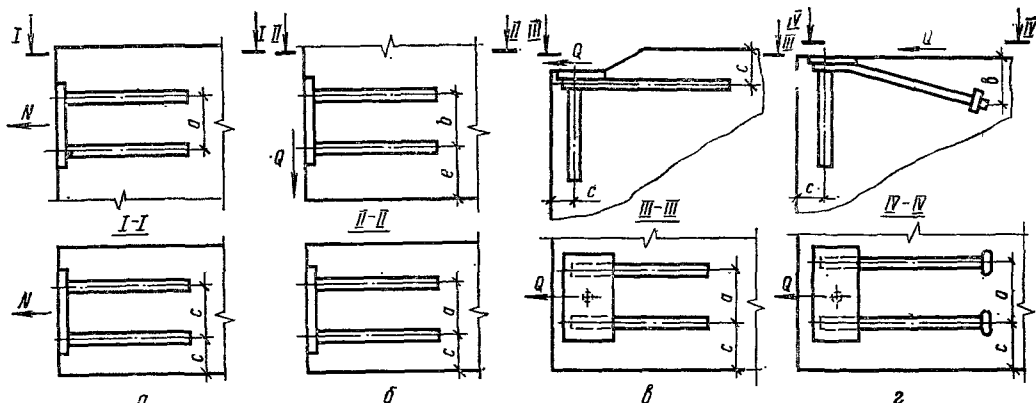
Наименьшие расстояния между анкерами закладной детали и от анкеров до края бетона: a, b — при работе нормальных анкеров на соответственно осевые и поперечные силы; a — при работе касательных анкеров на осевые силы; c — то же, при отогнутых усиленных анкерах. При анкерах из сталей классов А-II и Ас-II $a = 4d, b = 6d, c = 3d, e = 8d$; при анкерах из стали класса А-III $a = 5d, b = 7d, c = 3,5d, e = 8d$ (d — диаметр стержня, требуемый по расчету).
